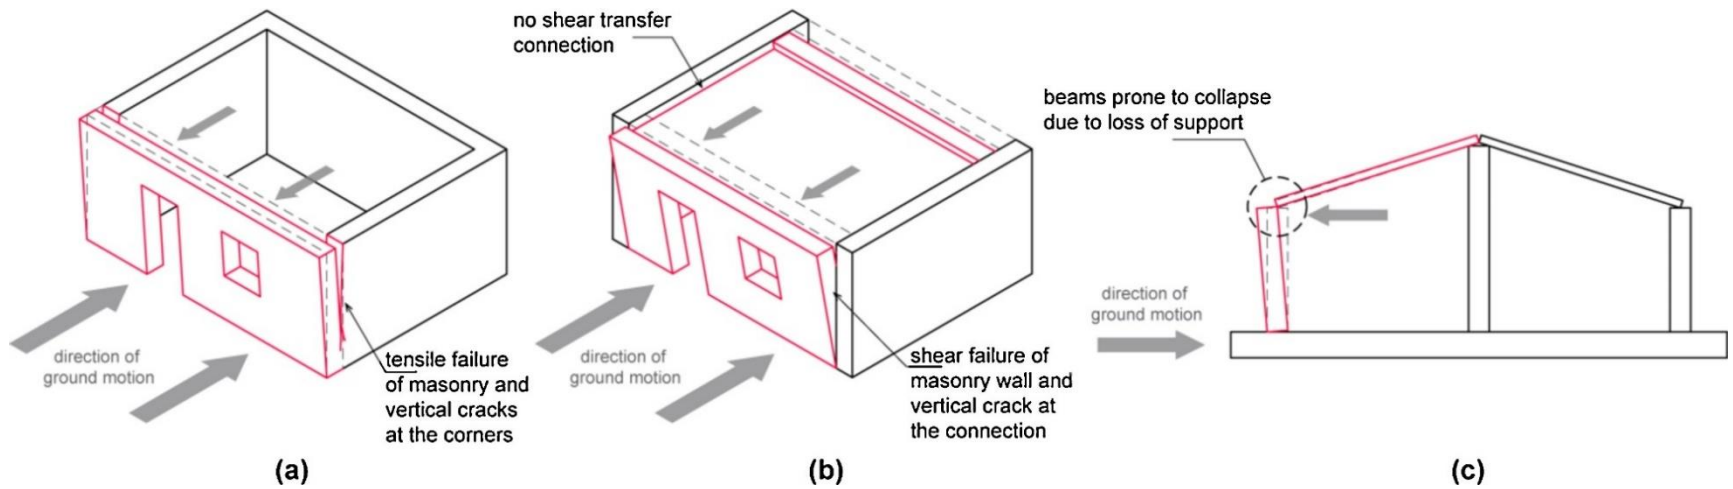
a) Giro global de las paredes externas; (b) falta de anclaje entre las paredes y los diafragmas horizontales que lleva al vuelco de las paredes; y (c) separación de pisos y techos de las paredes. Fuente: Paulo B. Lourenço.
